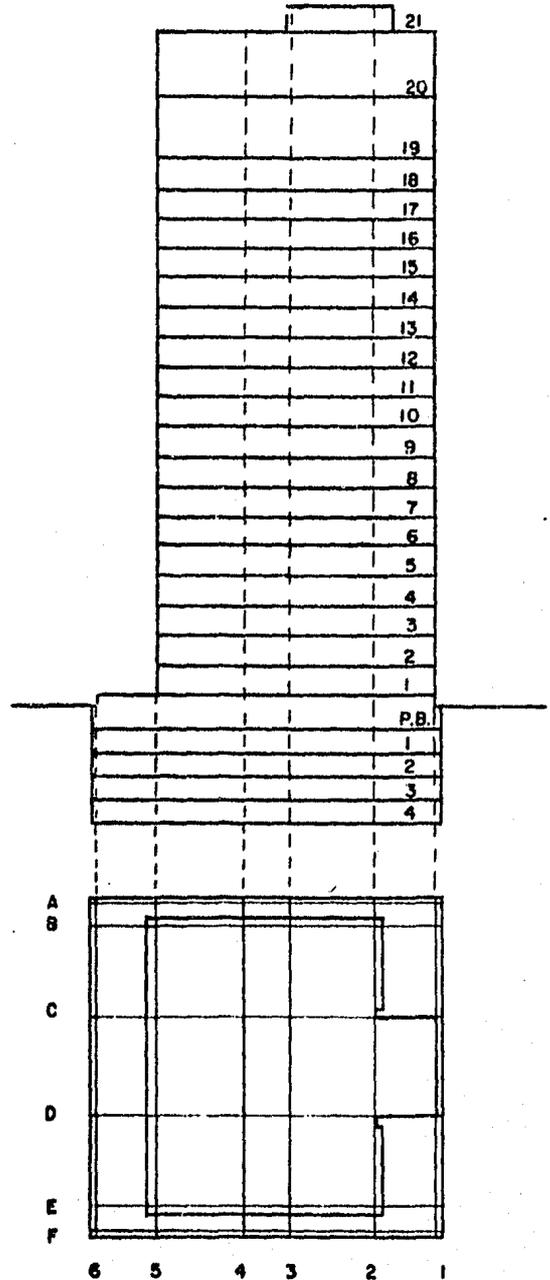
PROYECTO ARQUITECTONICO DEL EDIFICIO PARA OFICINAS.
